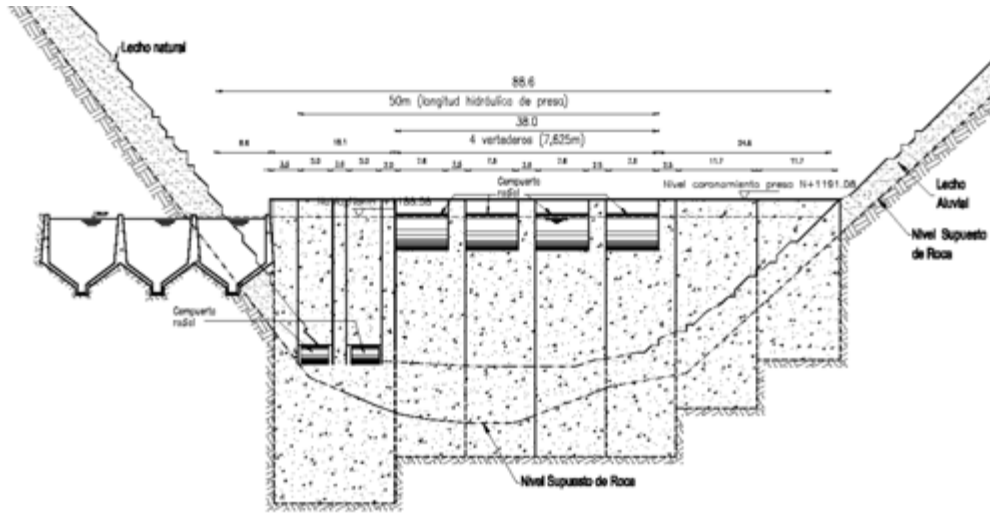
4 Sección Longitudinal Presa Santa Cruz Corte (C-C)
